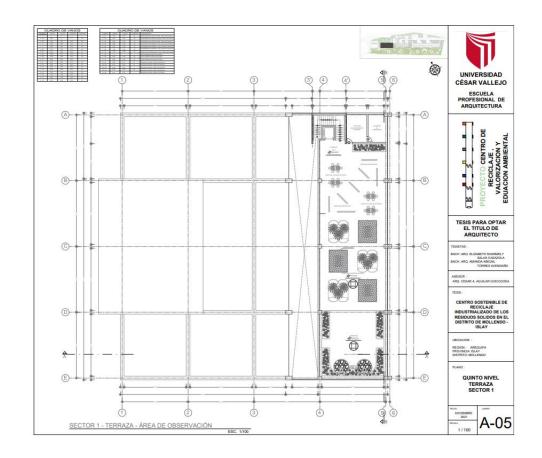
Planta de Distribución, Sector 1 — Quinto Nivel FUENTE: Elaboración Propia
